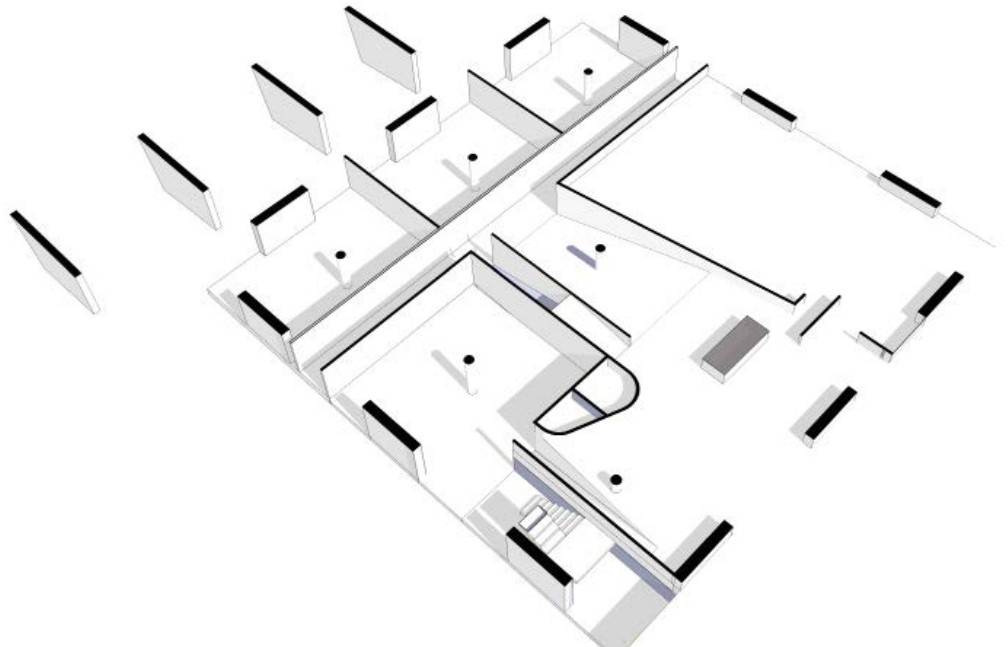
Isometría de la planta del nivel 1. Fuente: MCHS.
